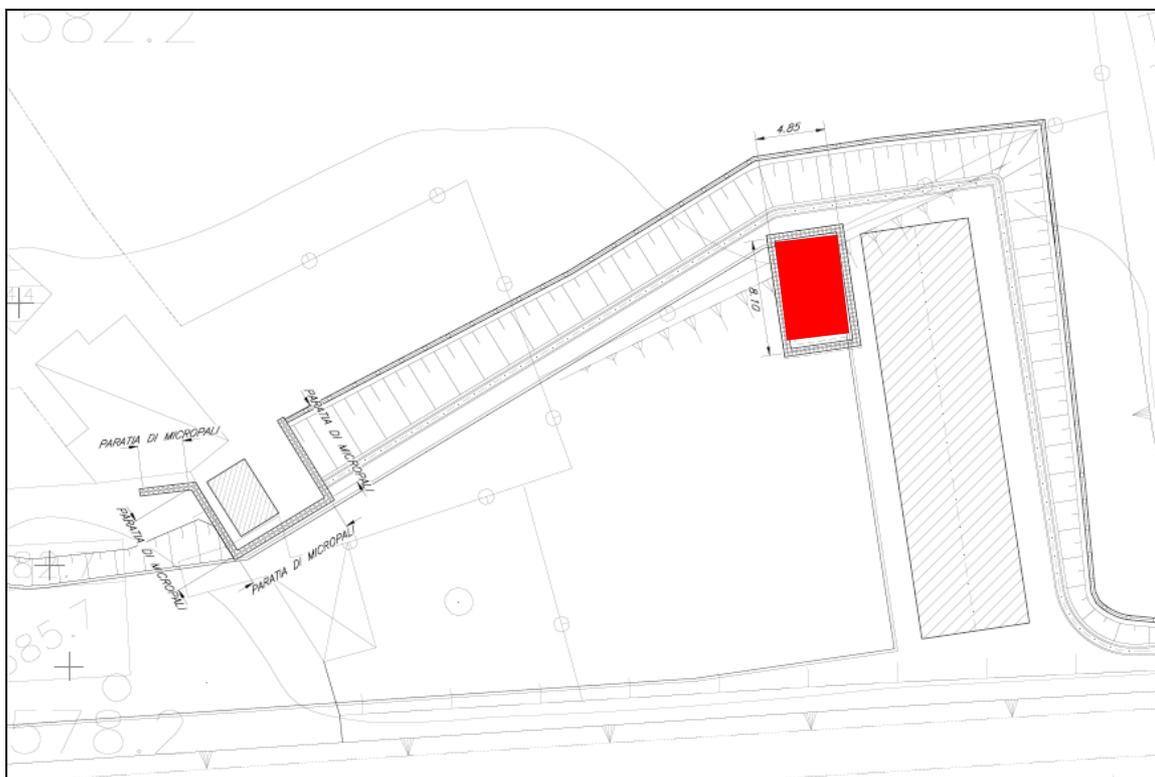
Estratto planimetria generale – posizione vasca impianto di sollevamento indicata in rosso
